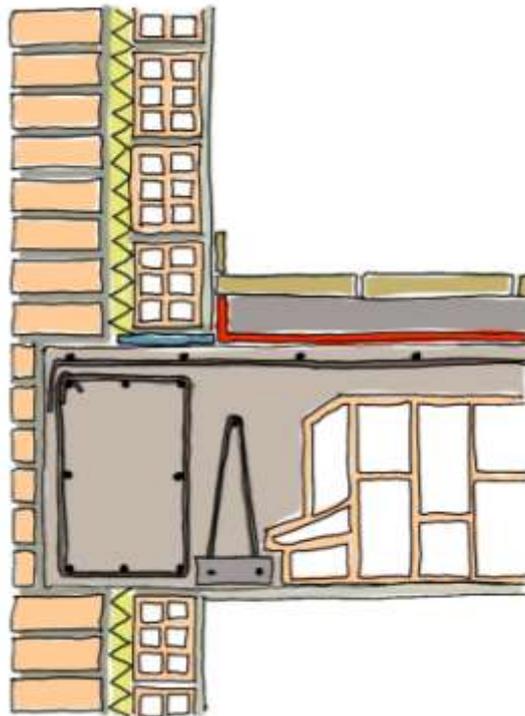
Sección de fachada tradicional. Fuente: elaboración propia
